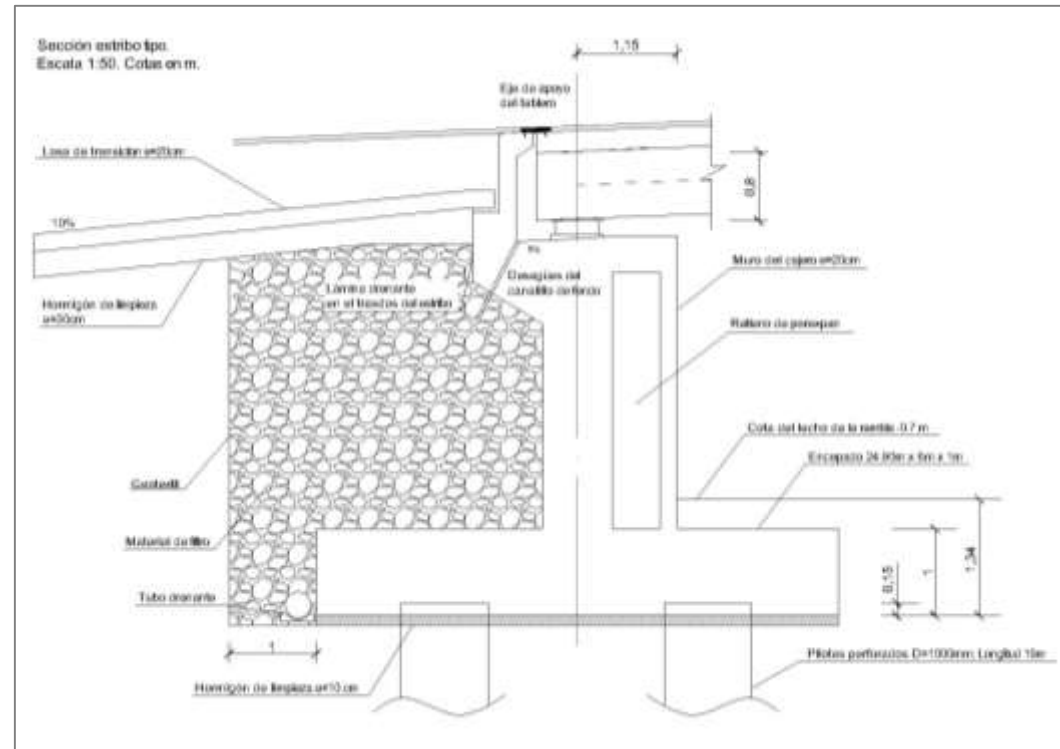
Sección del estribo. Fuente: Elaboración propia.
